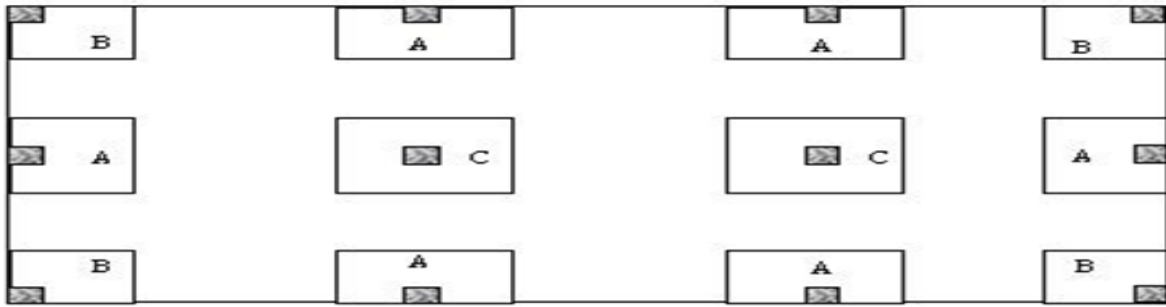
Zapatas aisladas: Medianera (A). Esquina (B). Interior (C) (Fuente: Martínez Quiroz, Enrique Napoleón, 2016)
